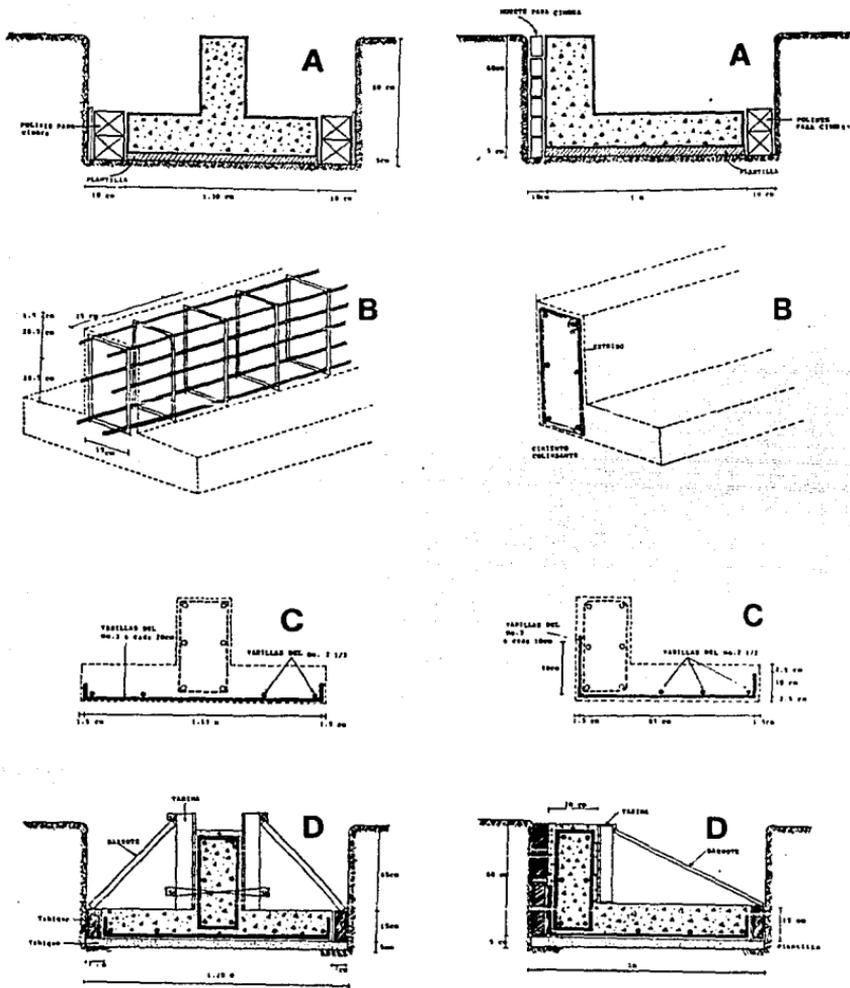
PROCESO CONSTRUCTIVO DE ZAPATAS
